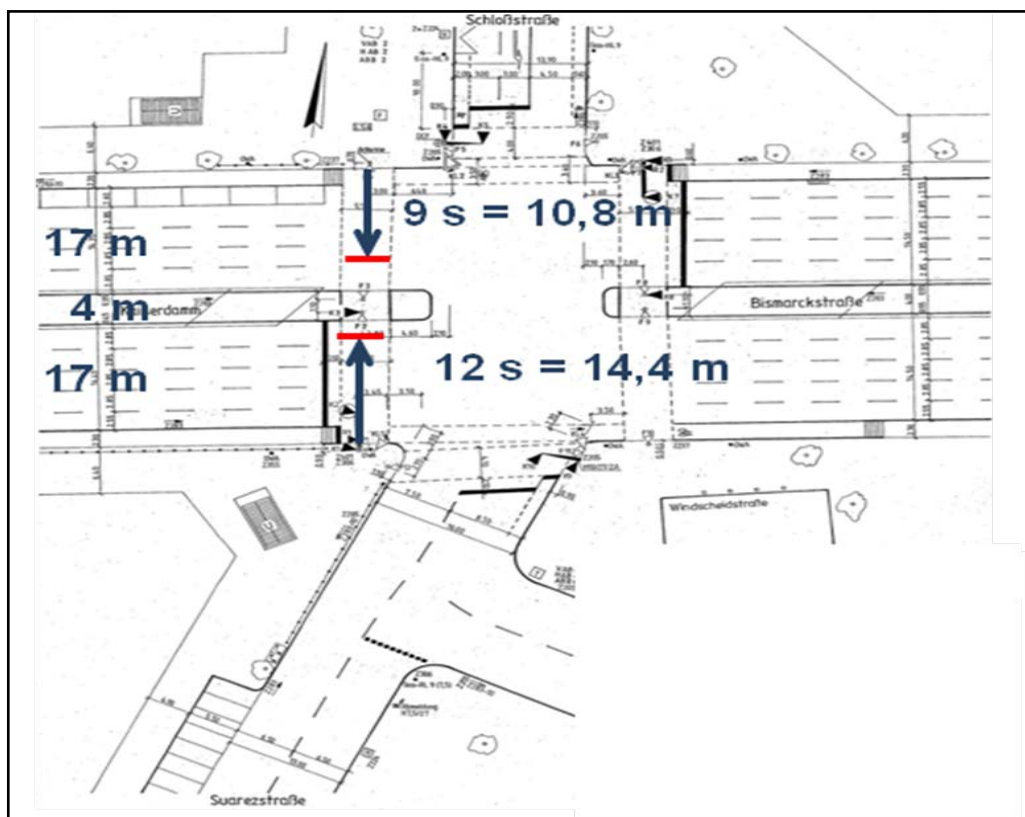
Lageplan Knotenpunkt Bismarckstraße/ Kaiserdamm
